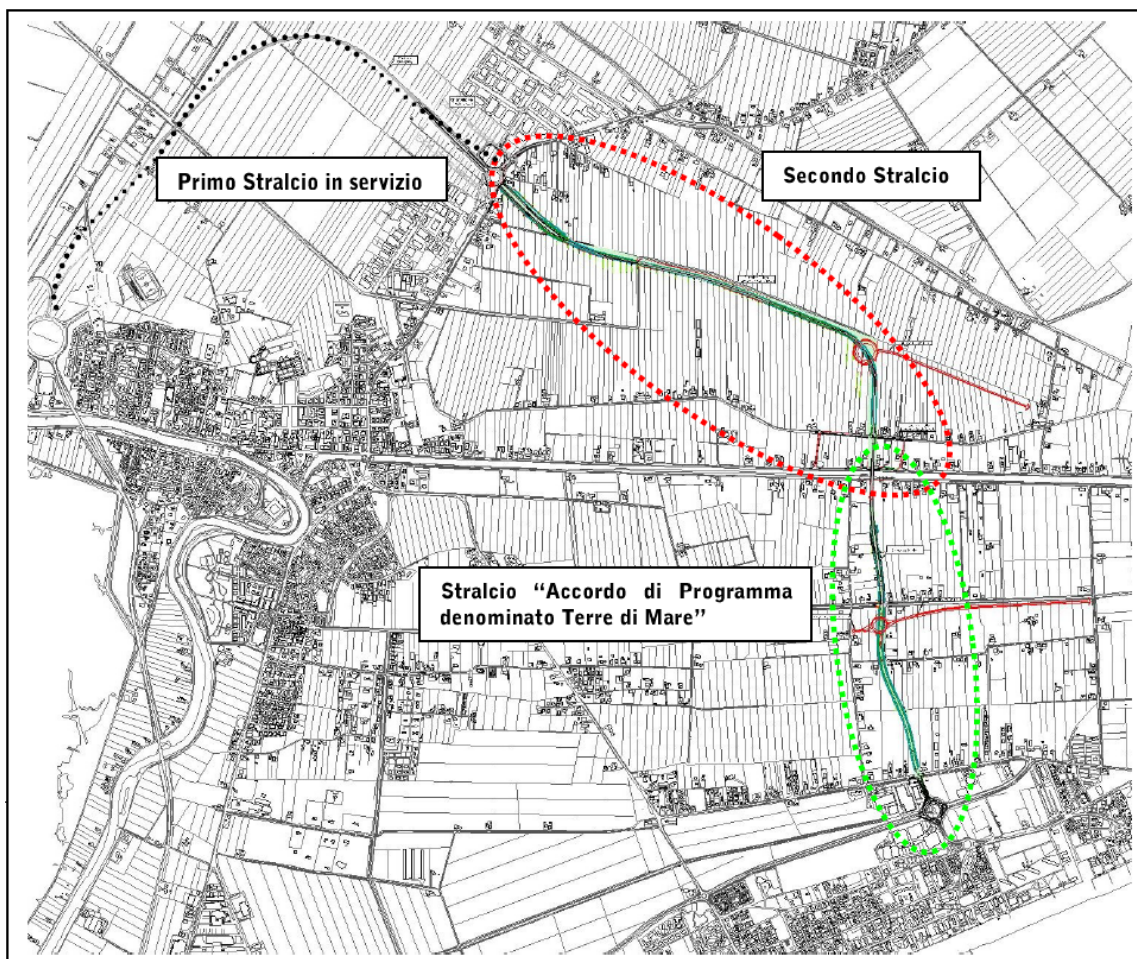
secondo stralcio oggetto di intervento, all'interno del tratteggio rosso.
